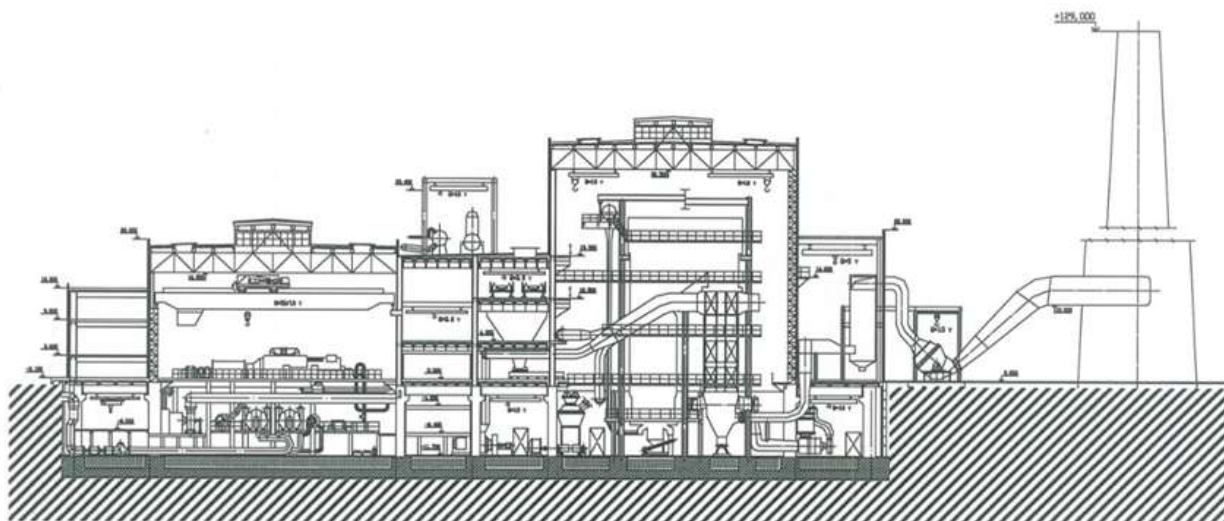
Поперечный разрез главного корпуса ТЭЦ-2 АО "АлЭС"
